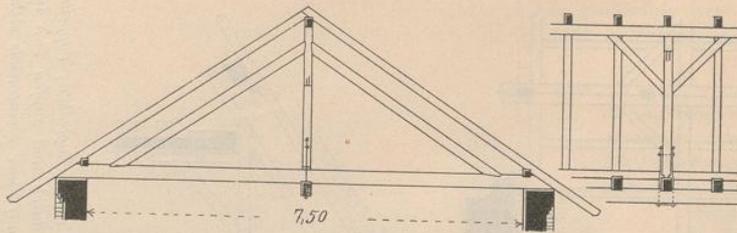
Dach mit einfachem Hängewerke bei nicht unterstützter Balkenlage. Dachlast und Deckenlast werden durch ein einfaches Hängewerk auf die Umfassungsmauern übertragen. Die Balken ruhen auf einem Unterzuge, der mit der Hängesäule durch Hängeeisen verbunden ist. Zur Unterstützung der Sparren dienen unten Fußspfetten, die aber auch fehlen könnten, da durchgängig Balken vorhanden sind; oben dient dazu eine Firstpfette, die auf die Hängesäulen gezapft ist.
